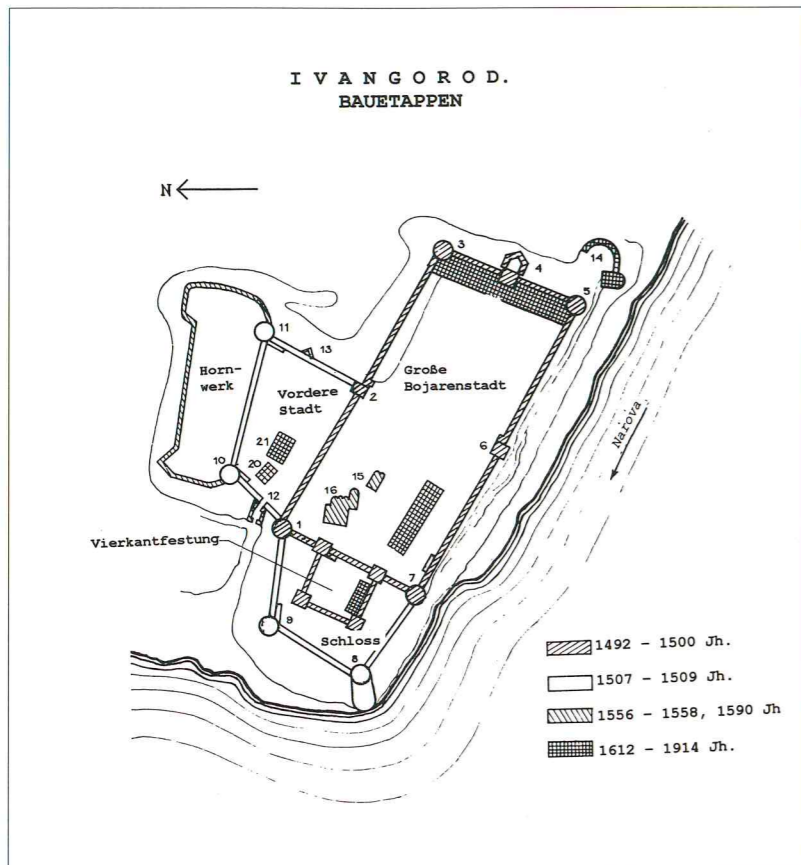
Die Festung Ivangorod. Grundrißschema und Bauetappen.
